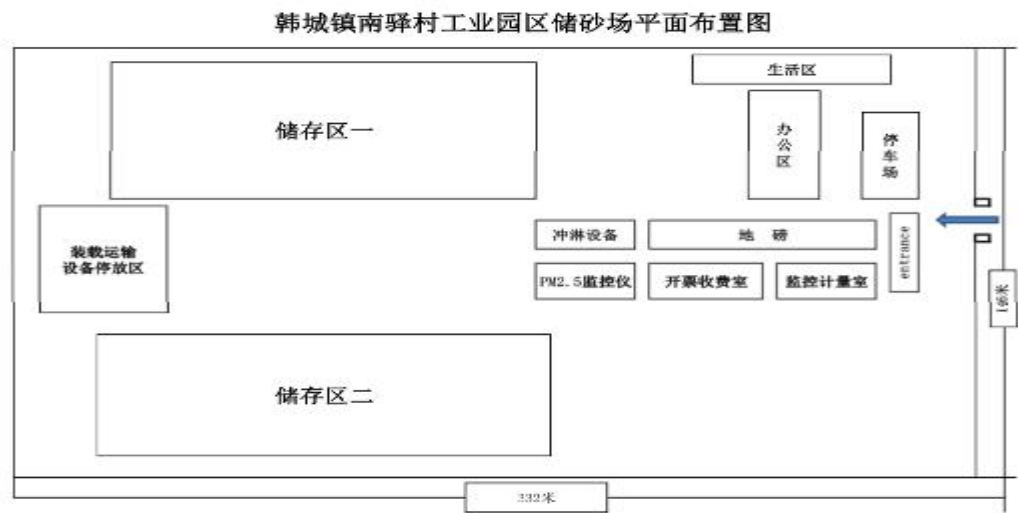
韩城镇南驿村工业园区储砂厂平面布置图
